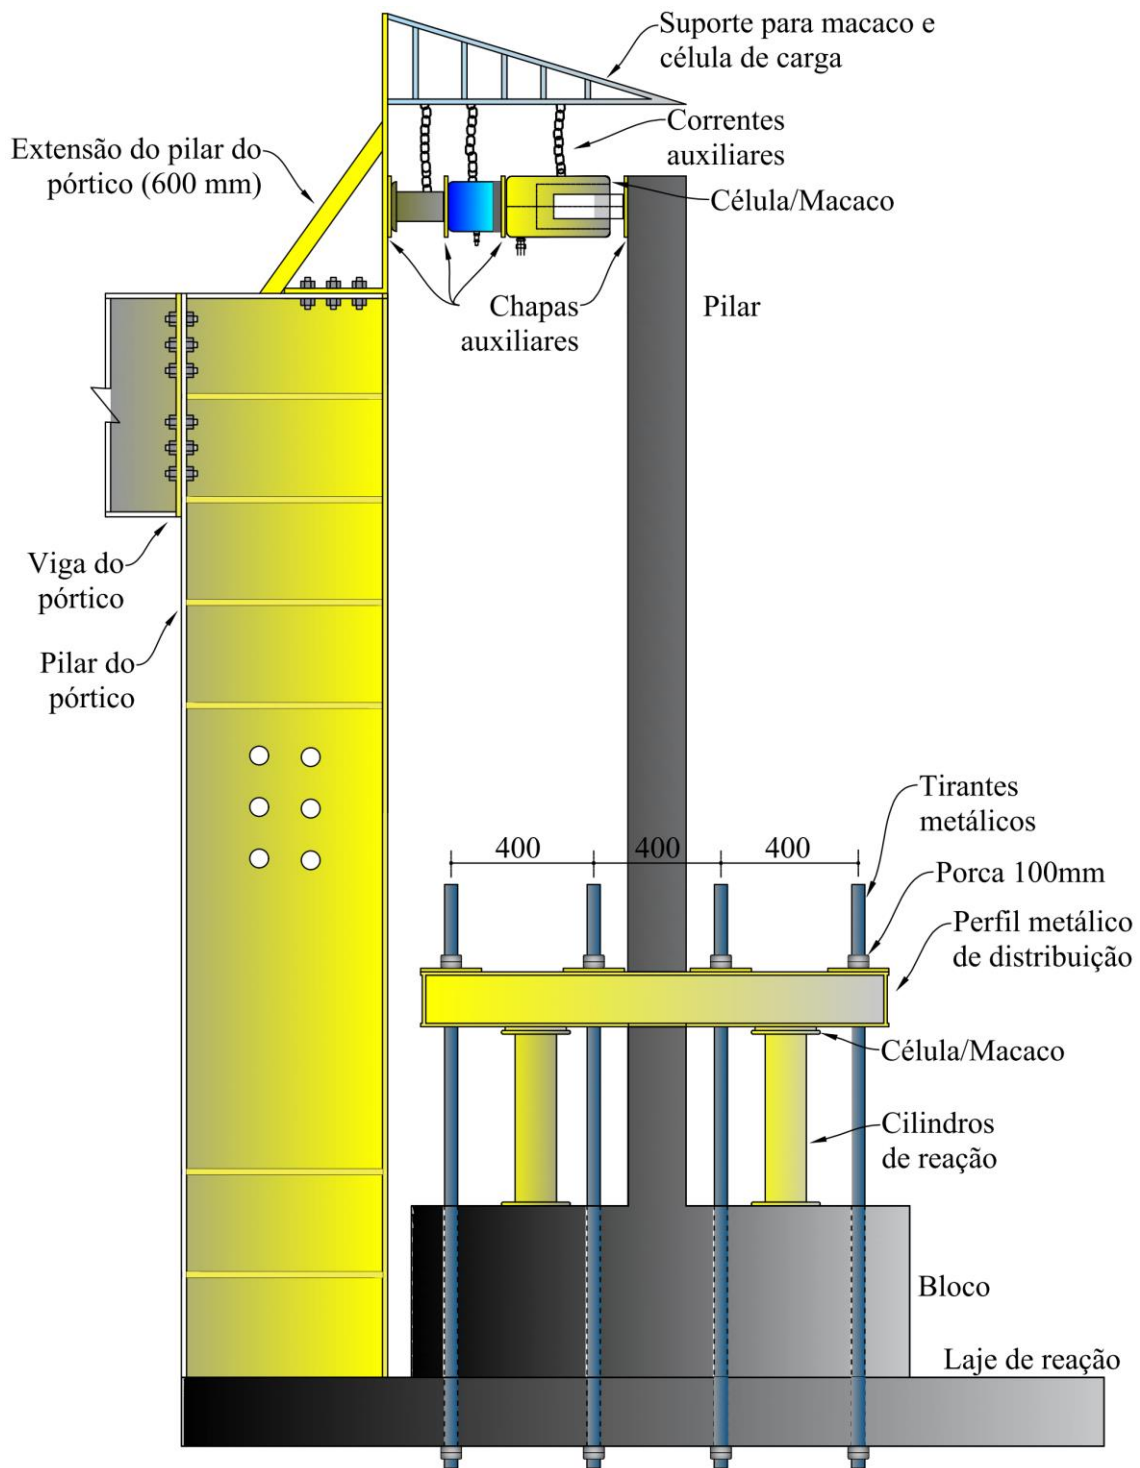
Sistema de ensaio do pilar P4 (Fonte: Autor)
